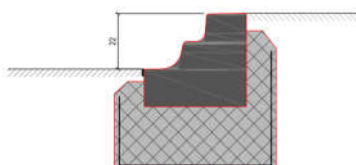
Détail bordure arrêt de bus LHand, hauteur 22 cm.
